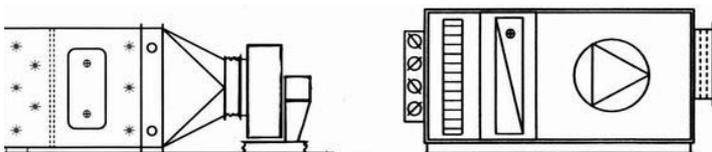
Варианты компоновки приточной установки в сборном исполнении, включающей утепленный клапан, воздушонагреватель, вентилятор, вентиляторный блок
